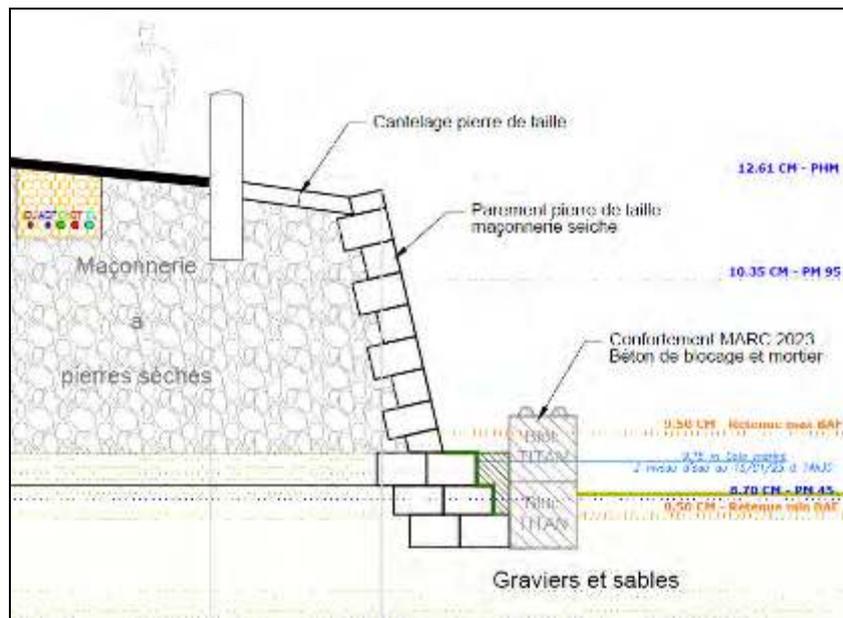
Plan coupe Existant – confortement provisoire MARC 2023.
